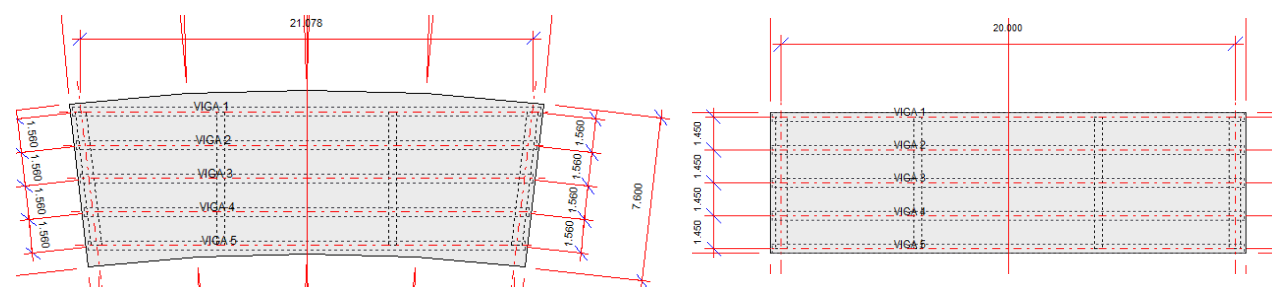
Plantas tableros de 6.20m de anchura. Fuente: IDOM-DEHC.
